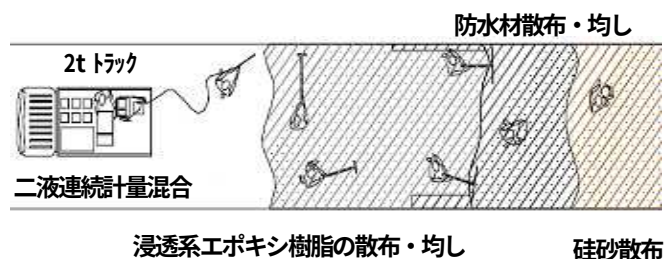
浸透系エポキシ樹脂による複合防水層の施工状況図
